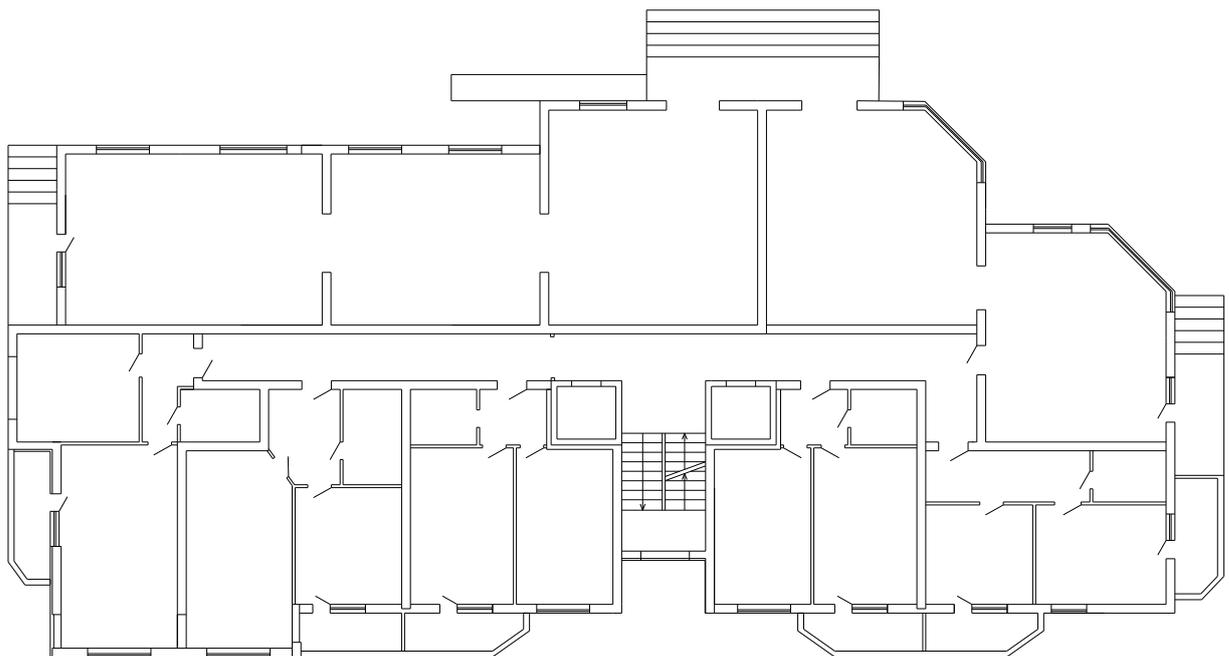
Планувальне рішення 1-го поверху будинку.
